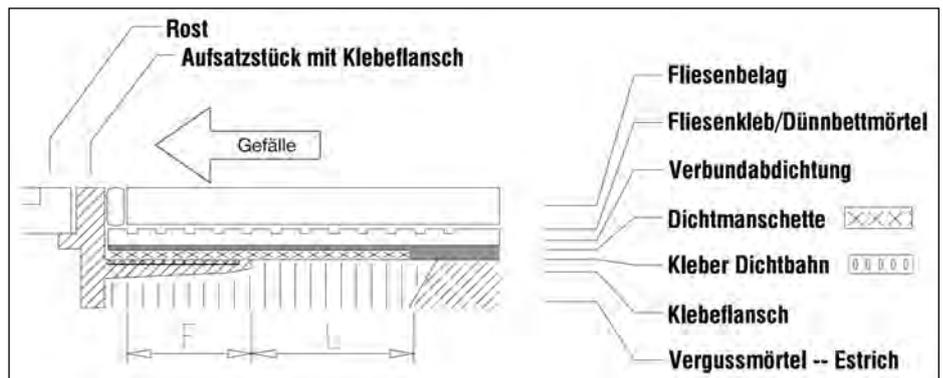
Details einer Klebeverbindung nach neuer ZDB-Fachinformation [13]
